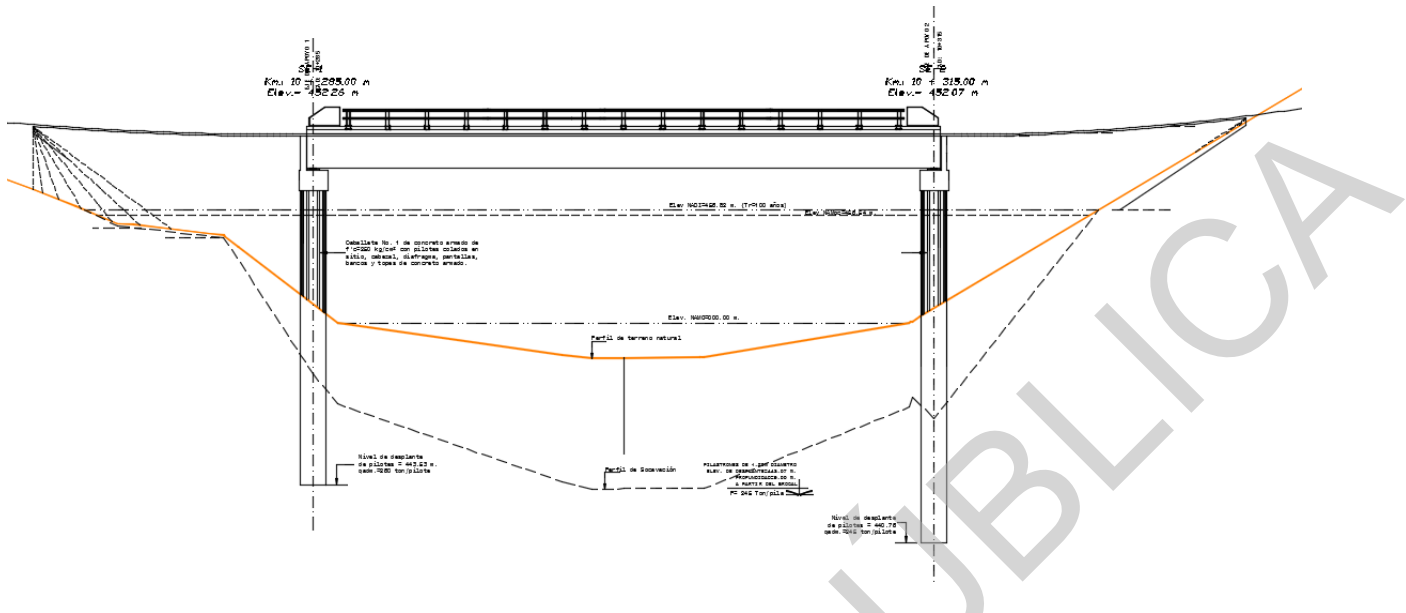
Elevación del eje del proyecto de construcción del puente "Río Bobo".
